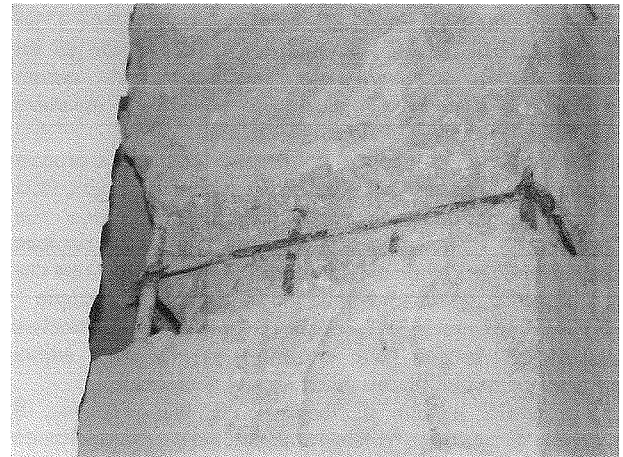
Danneggiamento di un pilastro per il passaggio di tubazioni impiantistiche
